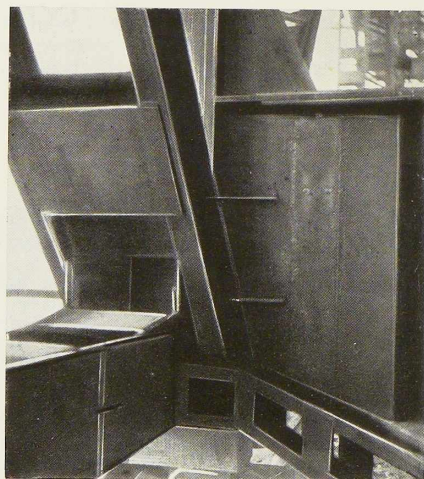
Assemblage de l'entretoise avec la ferme principale.
